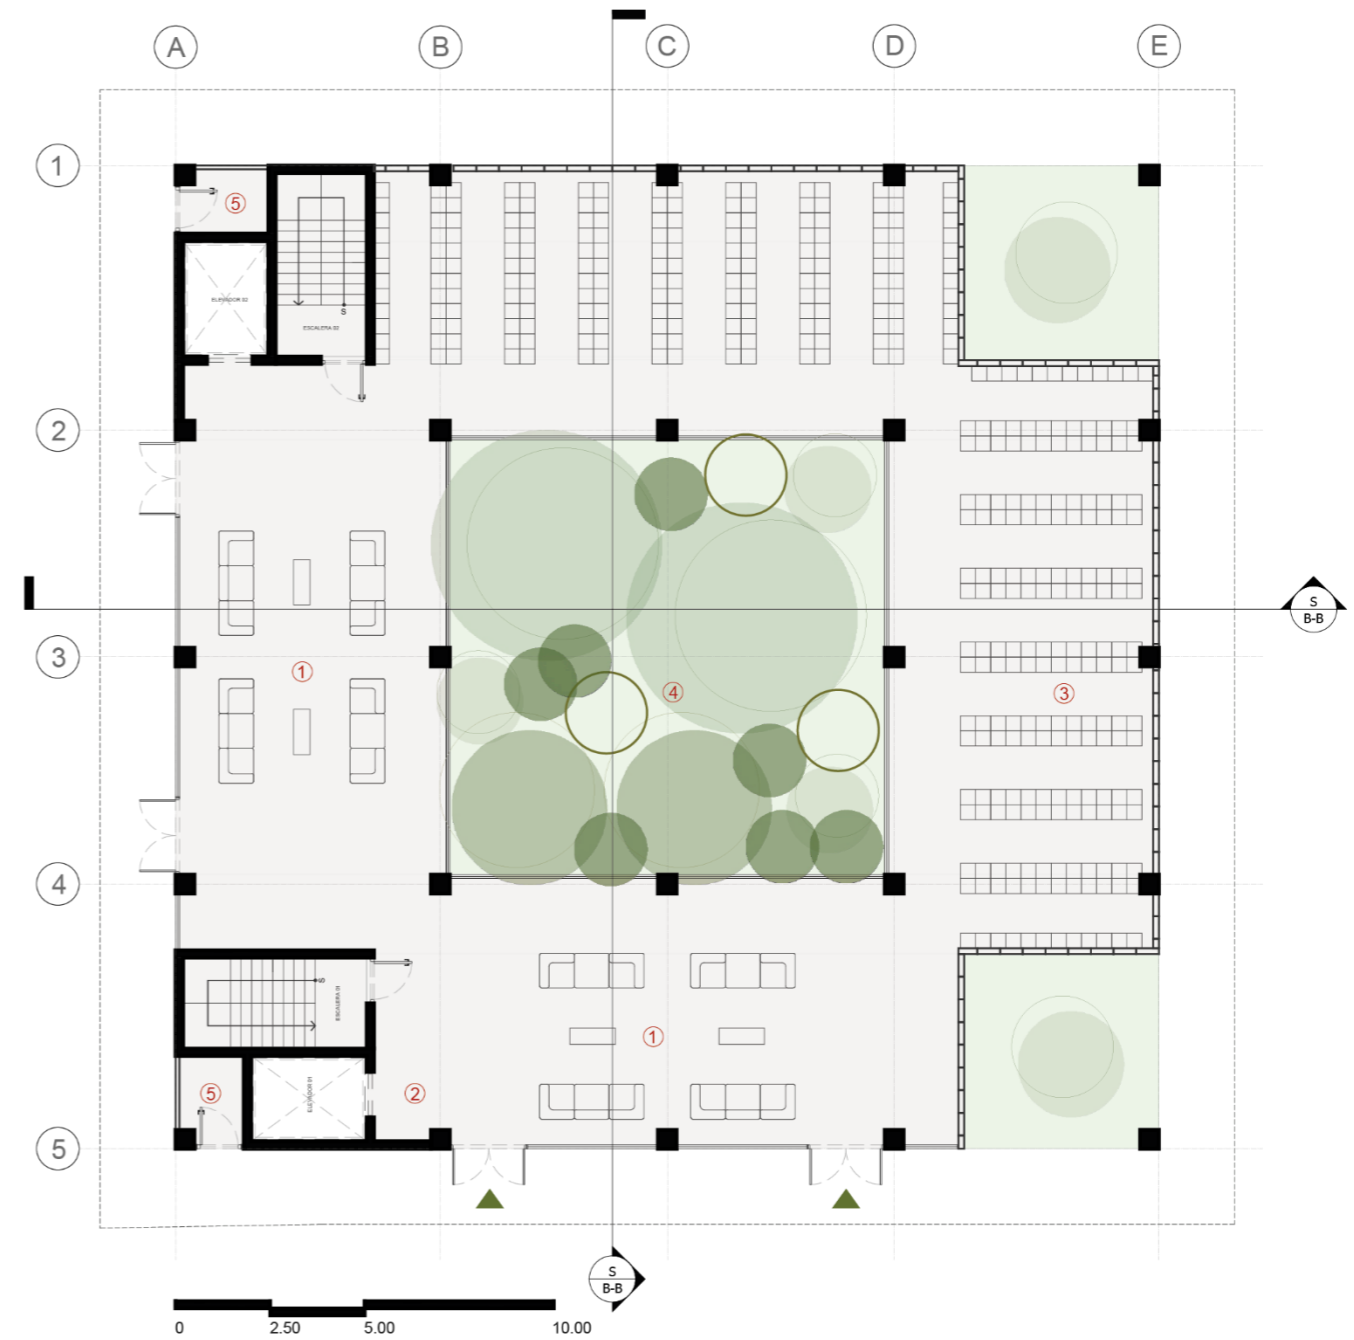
Planta arquitectónica de edificio 5: Cementerio Vertical N000
